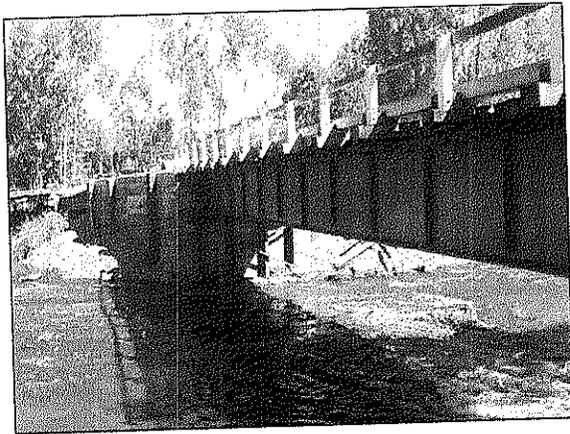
Vigas instaladas en puente Chucauco, no acordes a la especificación.
